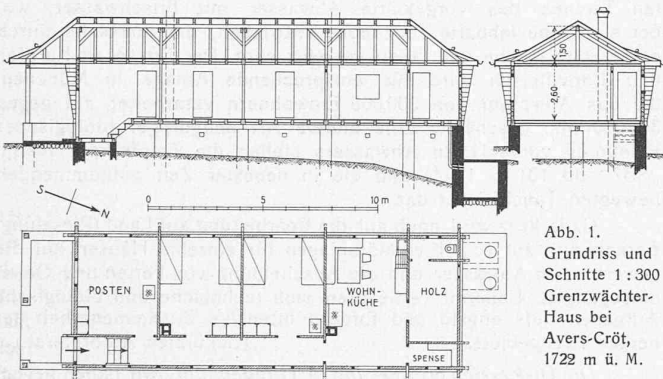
Grundriss und Schnitte 1:300 Grenzwächter-Haus bei Avers-Crôt, 1722 m ü. M.
